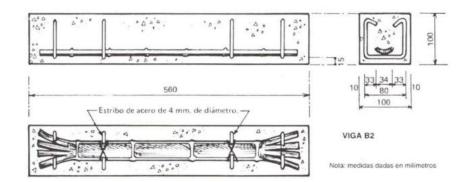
Viga (2) de hormigón reforzada con bambú. Fuente González Salcedo, 2001
